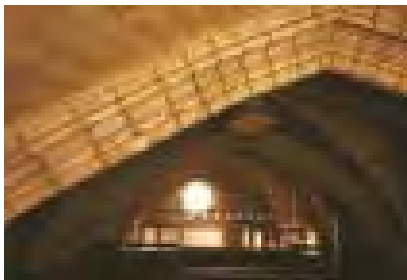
Detalle del arco perpiño entre el primero y el segundo tramos del transepto sur. Se aprecia la fisura en el intradós de la bóveda y la apertura entre las dovelas, ya una vez reparada con llaves metálicas
